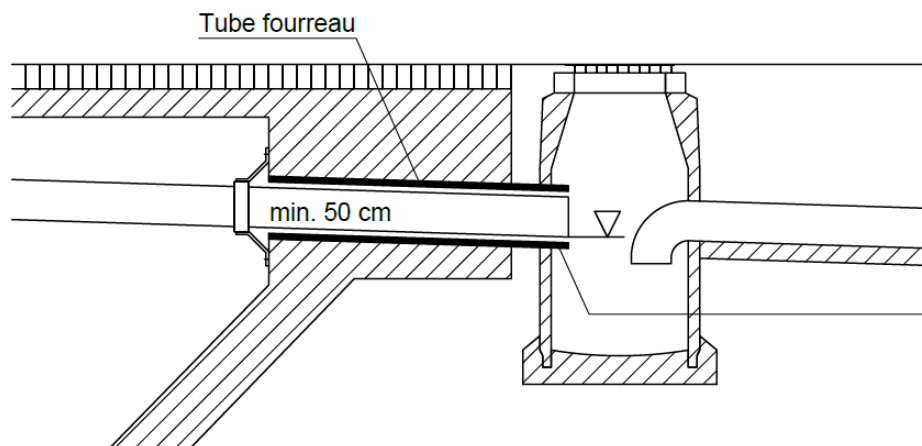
Conduite collectrice à l'extrémité du pont avec un dépotoir
